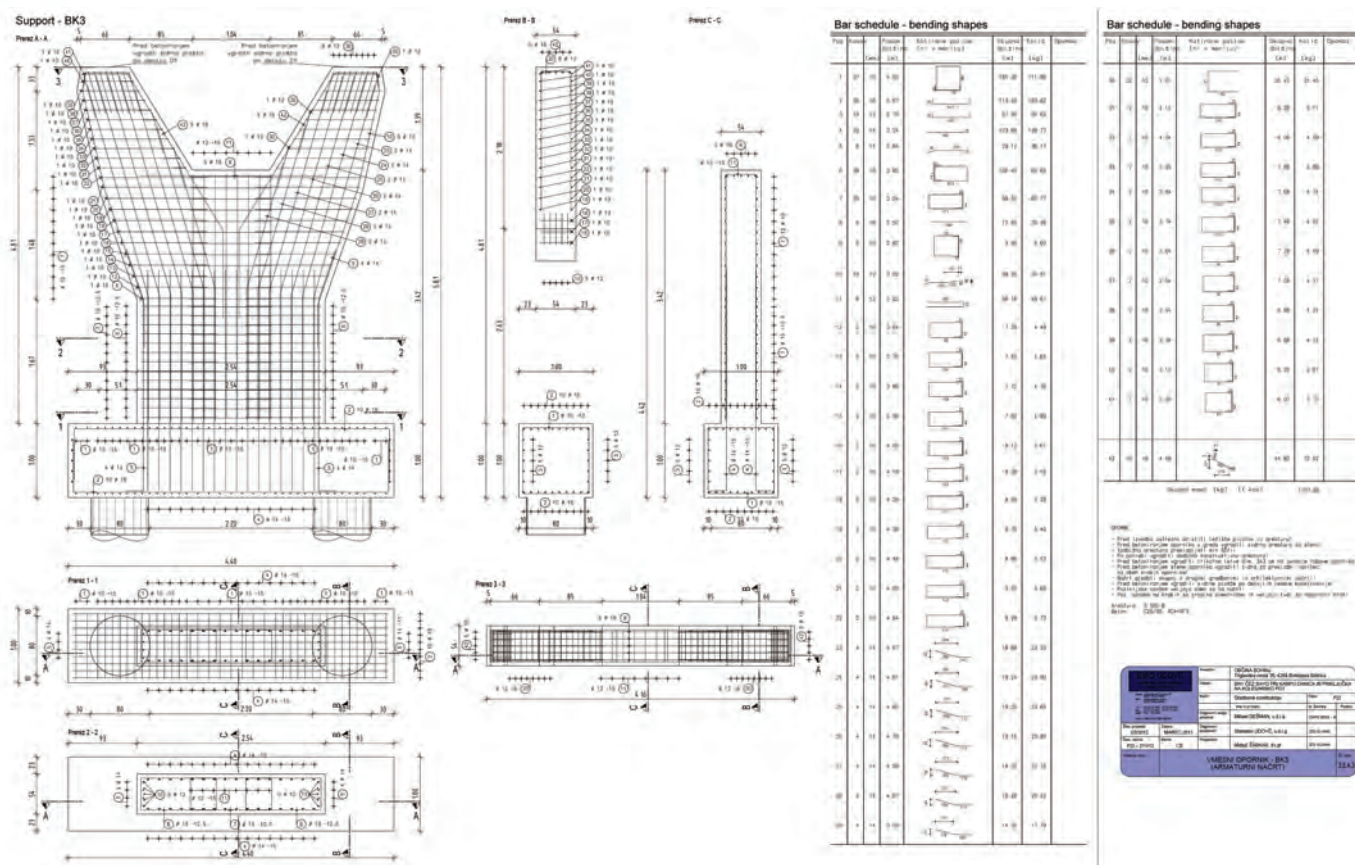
Exemplu de detaliere Nemetschek Allplan
